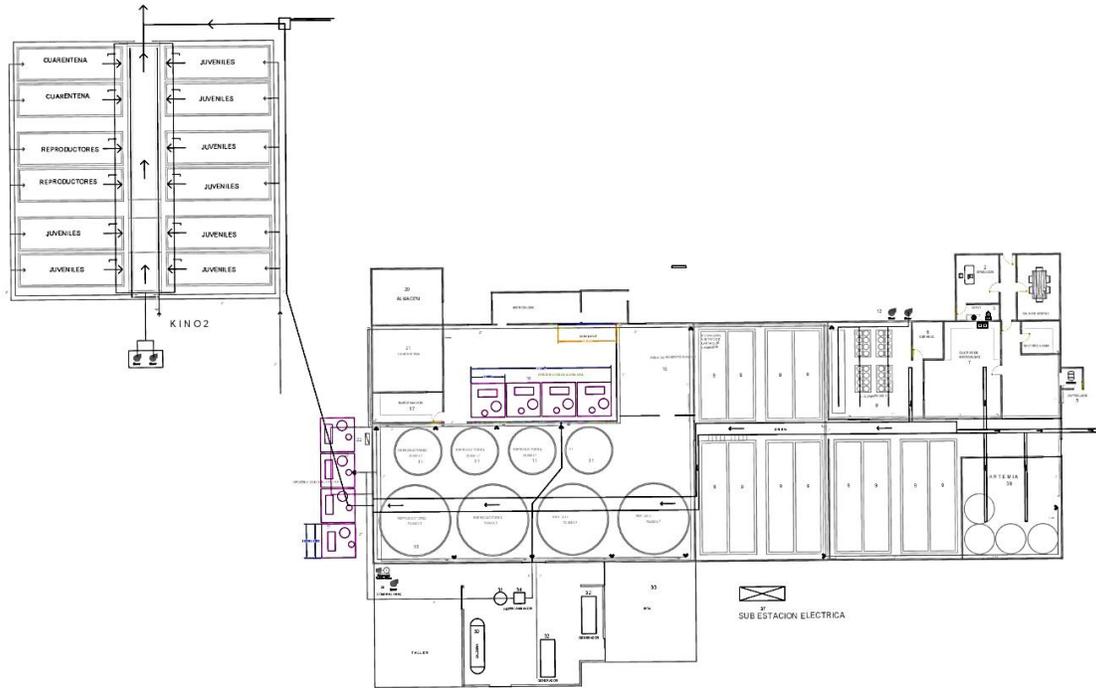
Planta arquitectónica CREMES Fuente: CREMES.
